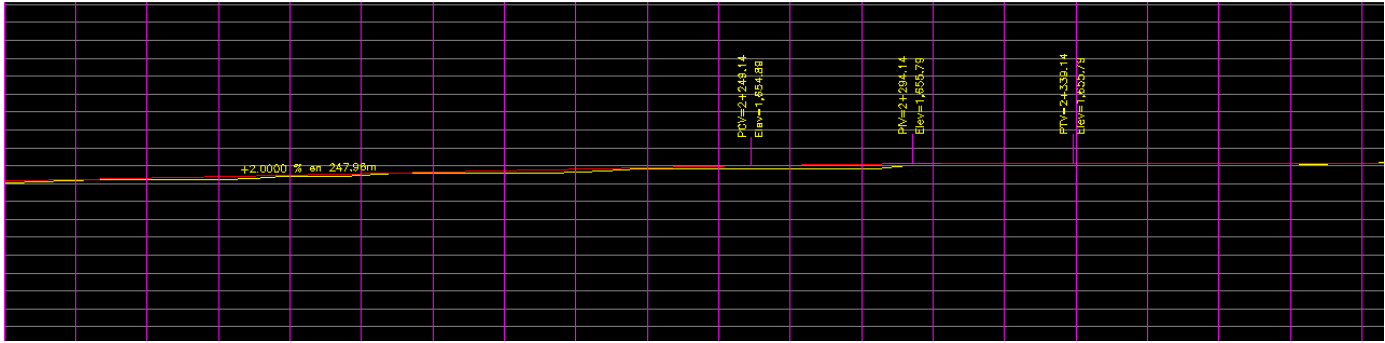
Perfil del terreno (amarillo) y alineamiento vertical (rojo) con etiqueta de pendientes e inflexión de curvas verticales (AutoCAD 2010).
